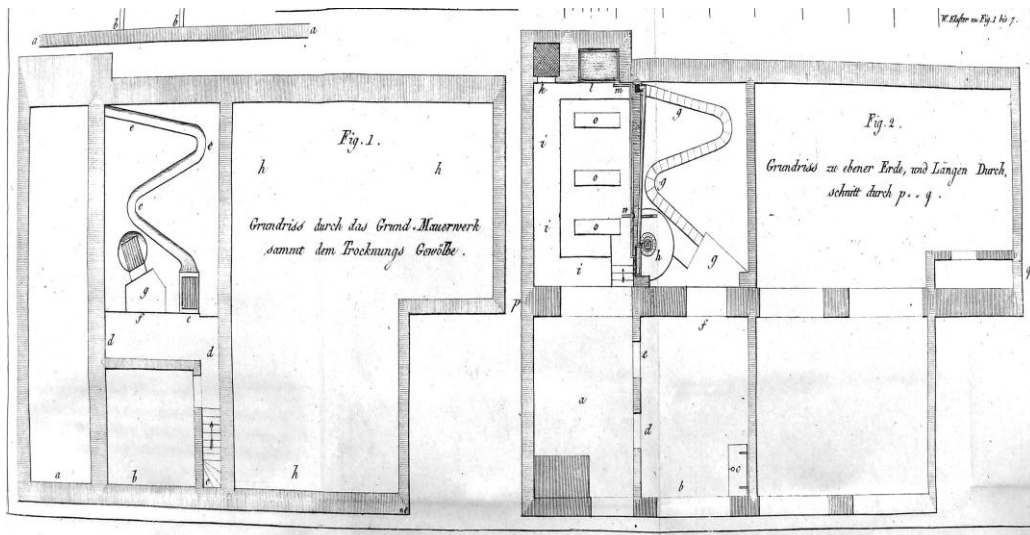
Grundriss zu ebener Erde, und Längendurchschnitt durch  $p = q$ .
